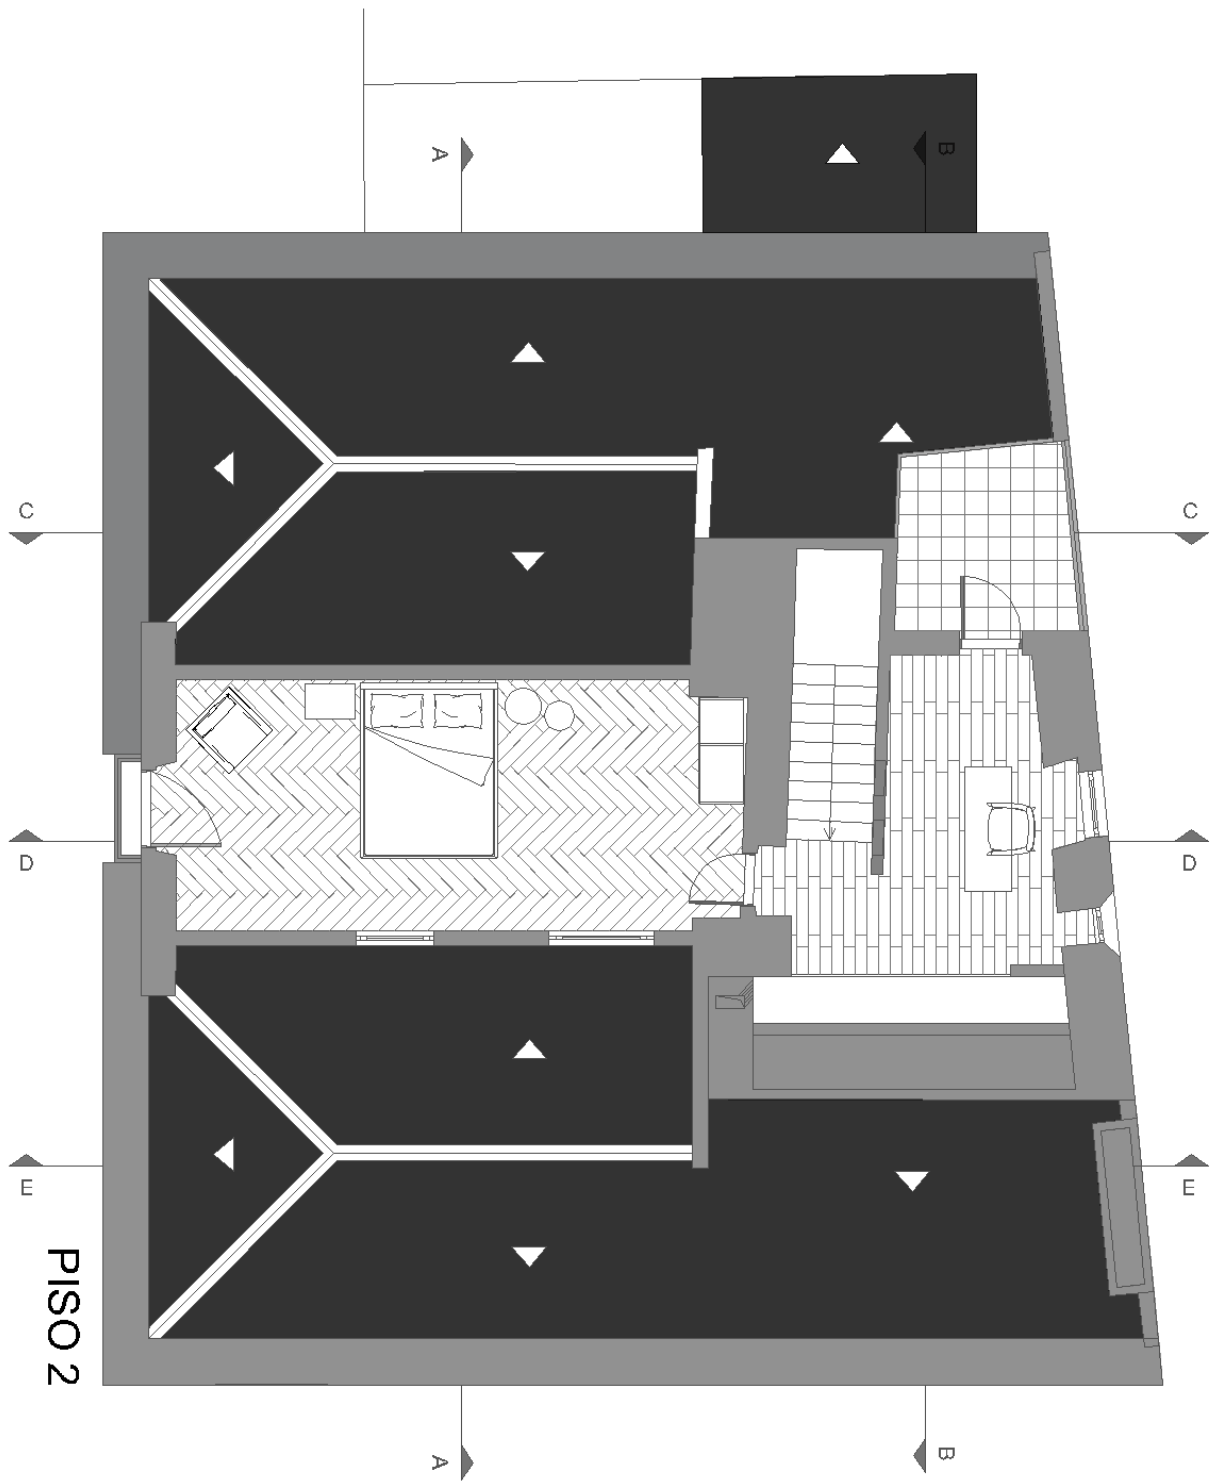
Planta do piso 2 com identificação dos cortes (Não está escada)
